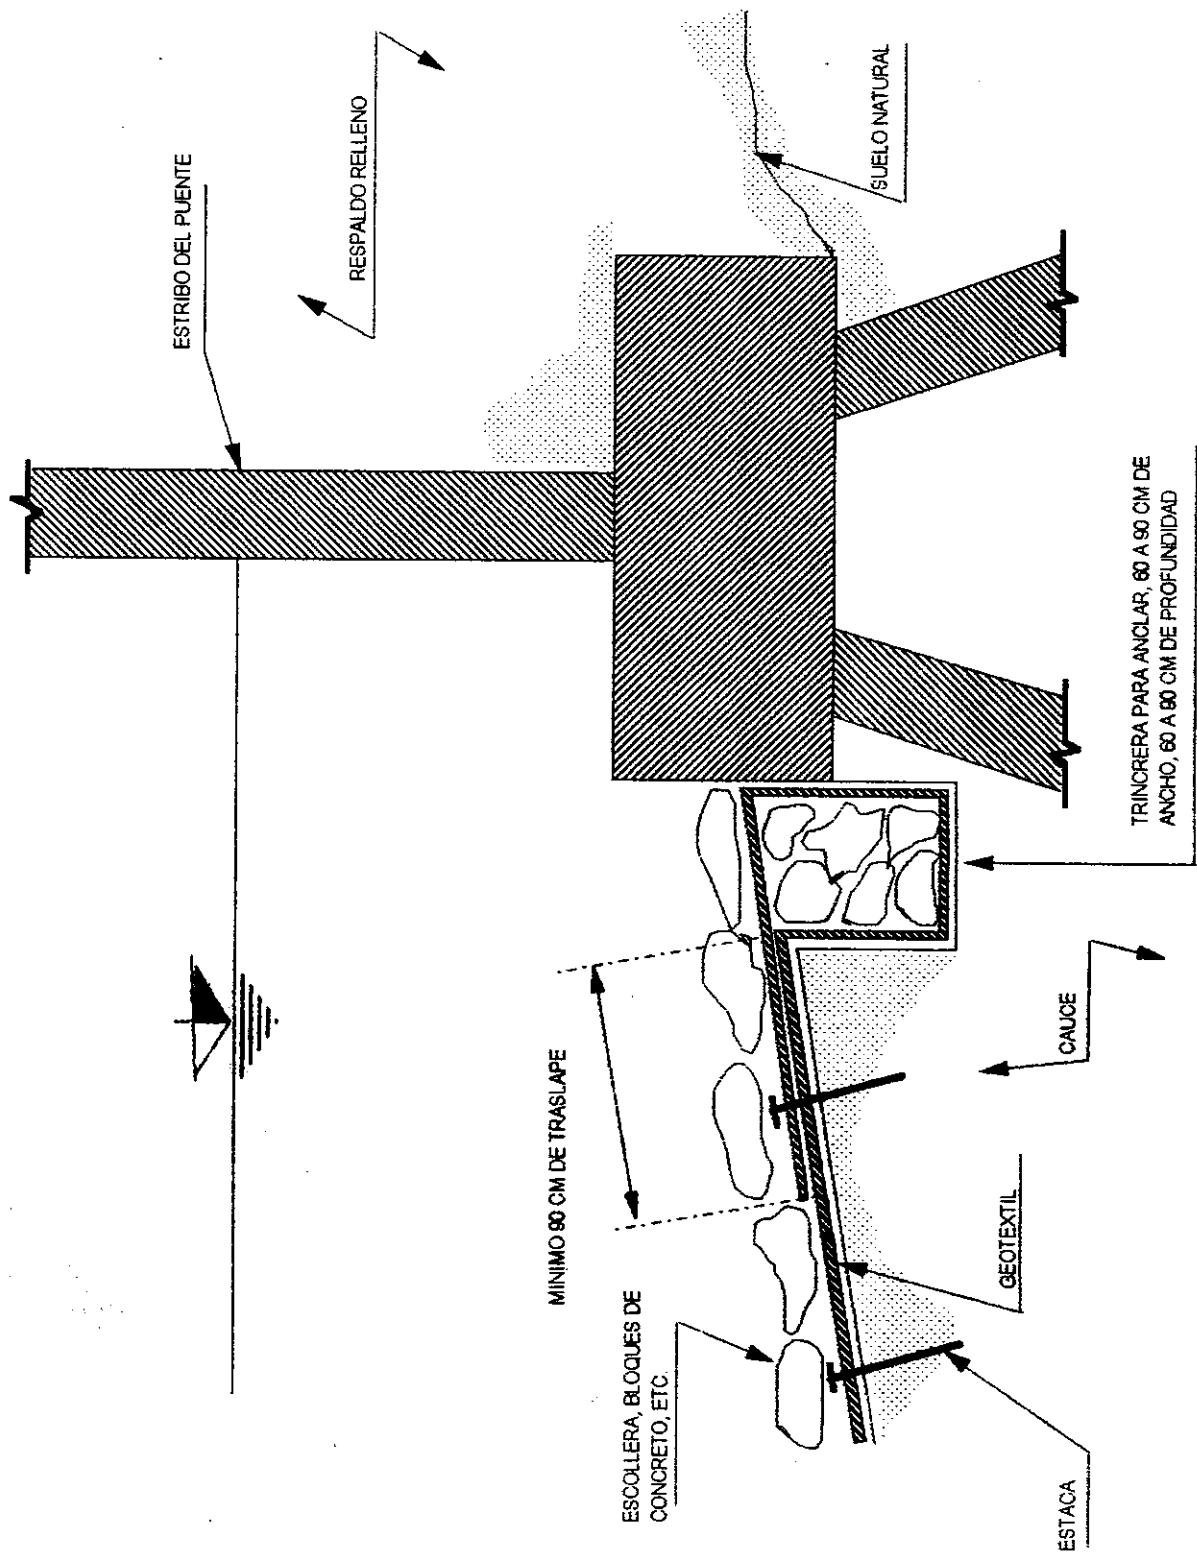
USO DE GEOTEXILES PARA LA PROTECCION DE ESTRIBOS DE PUENTES
